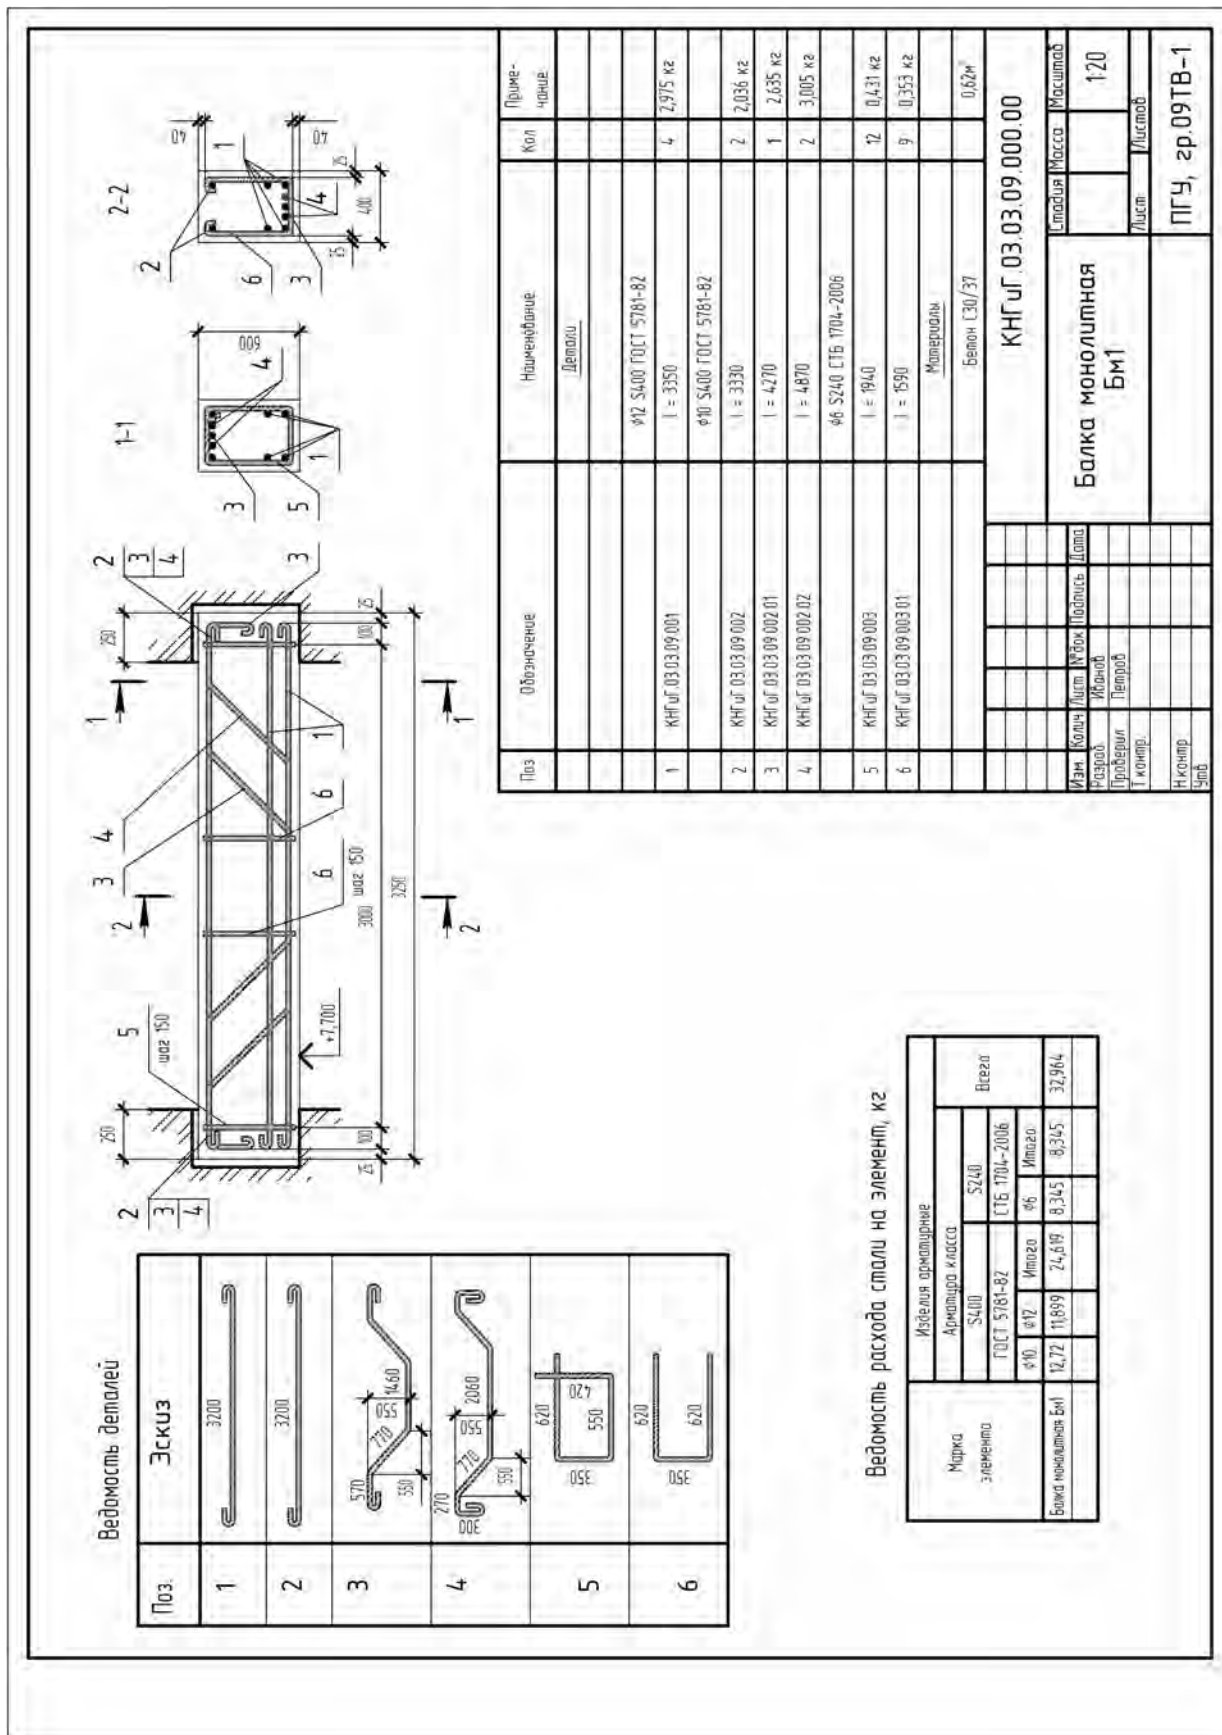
Сборочный чертеж монолитной балки БМ1
